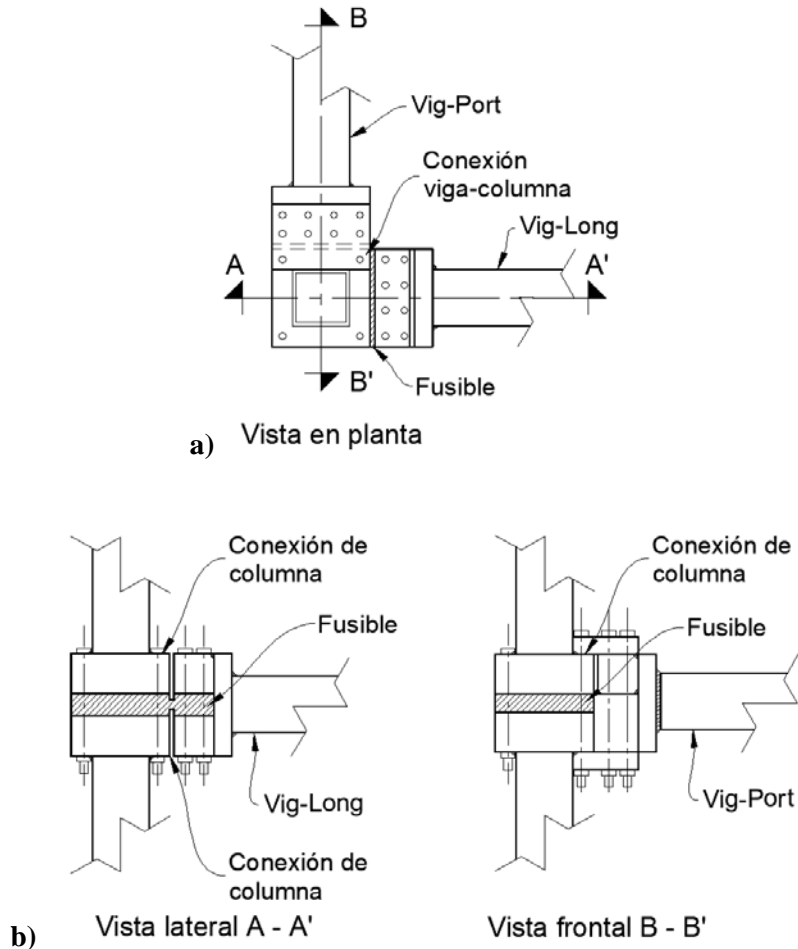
a) Planta tipo de conexión viga-columna de entrepiso y b) Vista lateral y frontal
